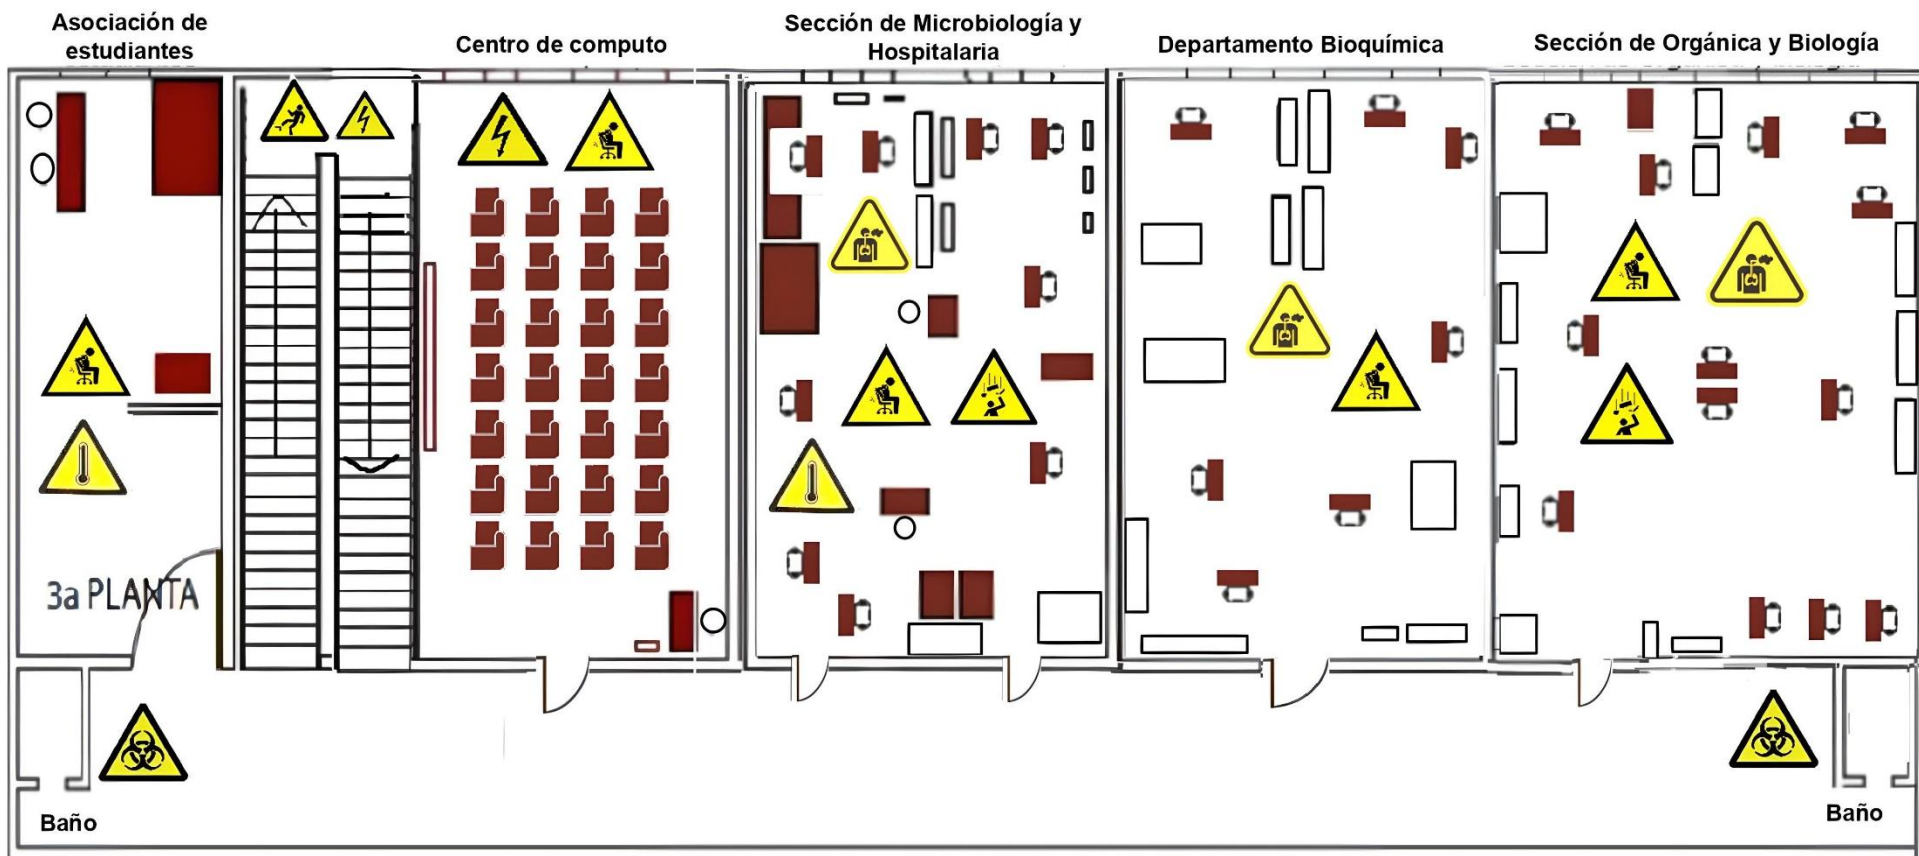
Mapa de riesgo vista en planta (sin escala) tercera planta⁵
